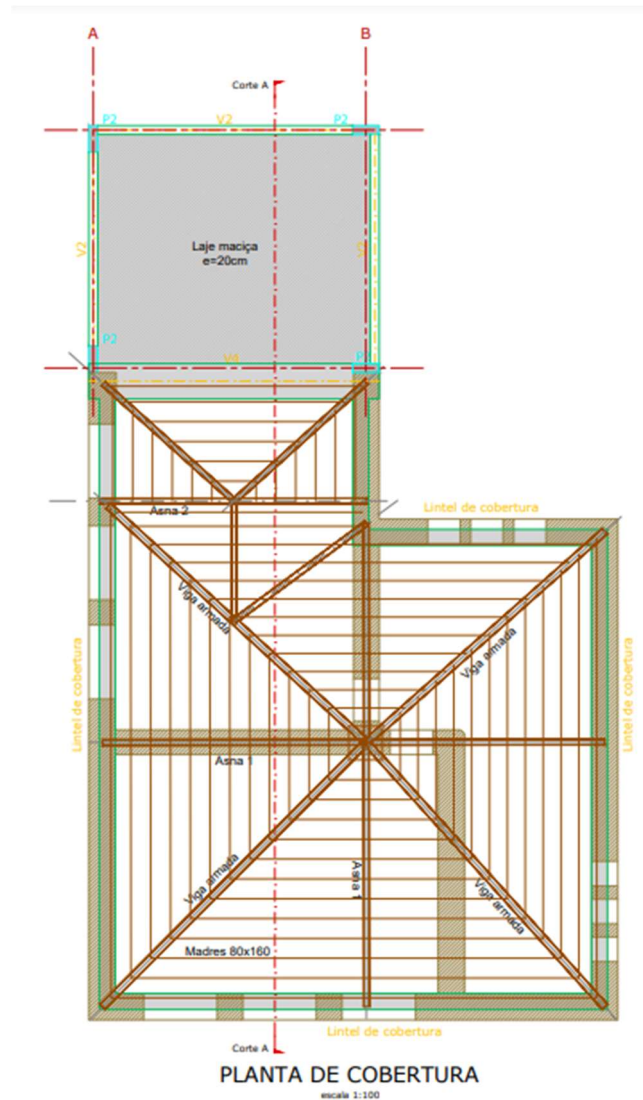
Planta da cobertura CACI (Eleven Steps, 2023)
